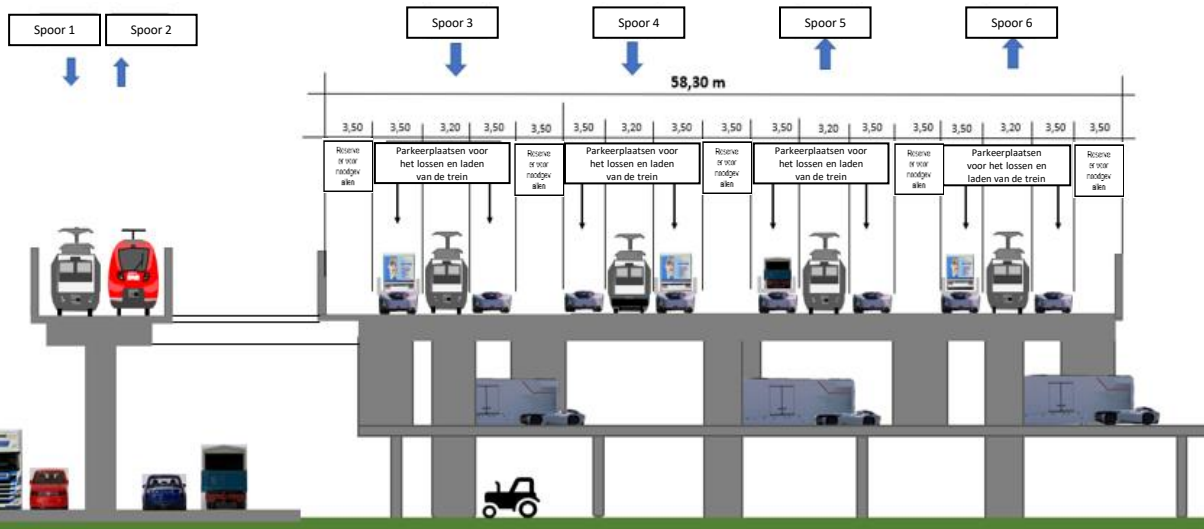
aansluiting bedrijventerrein Elmpt
